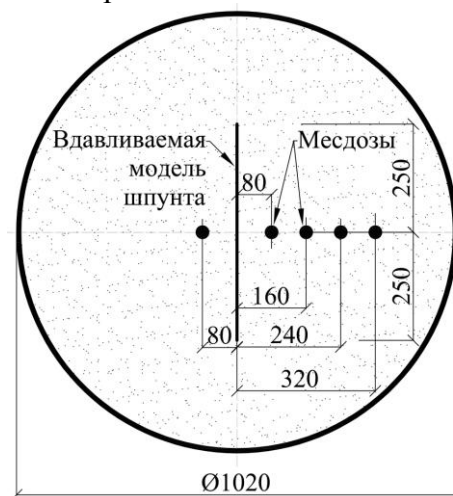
Поперечный разрез испытательной установки по оси расположения месдоз. Схема расположения месдоз
